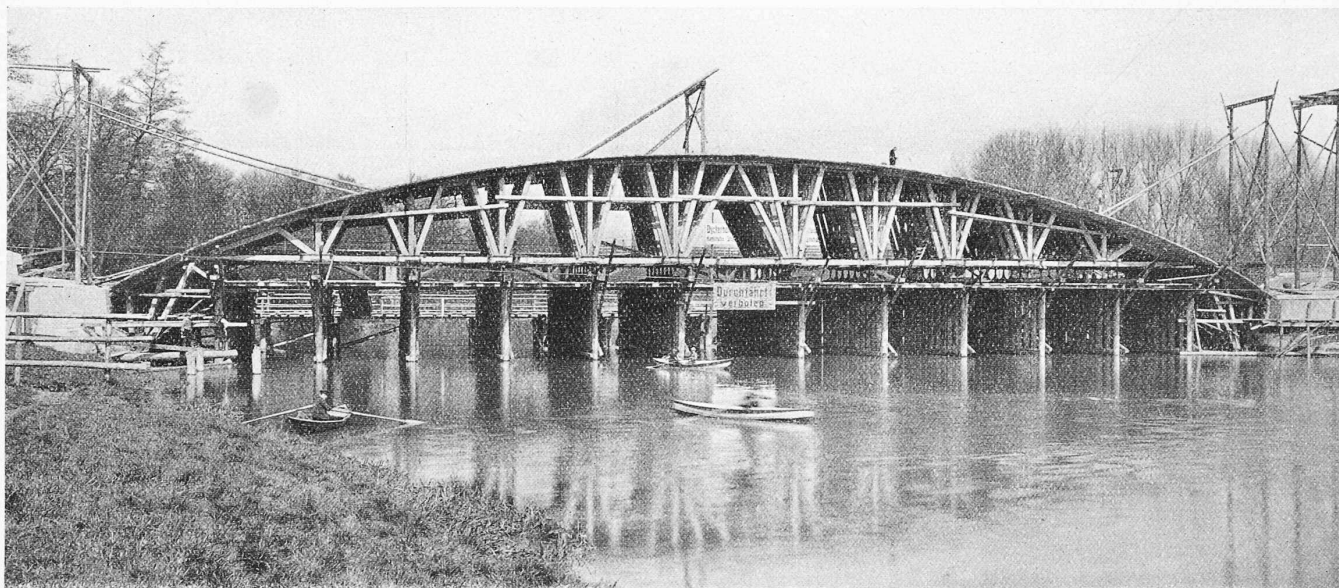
Lehrgerüst des Hauptgewölbes über der Flussöffnung, südliche Lage (16. IV. 1913).
